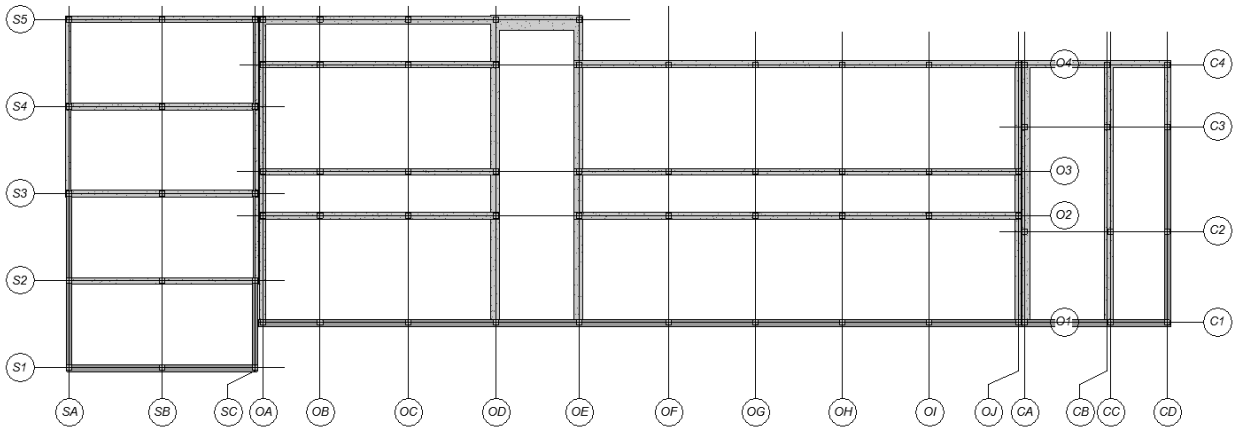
Vista en planta del forjado de planta baja de la zona Administrativa
